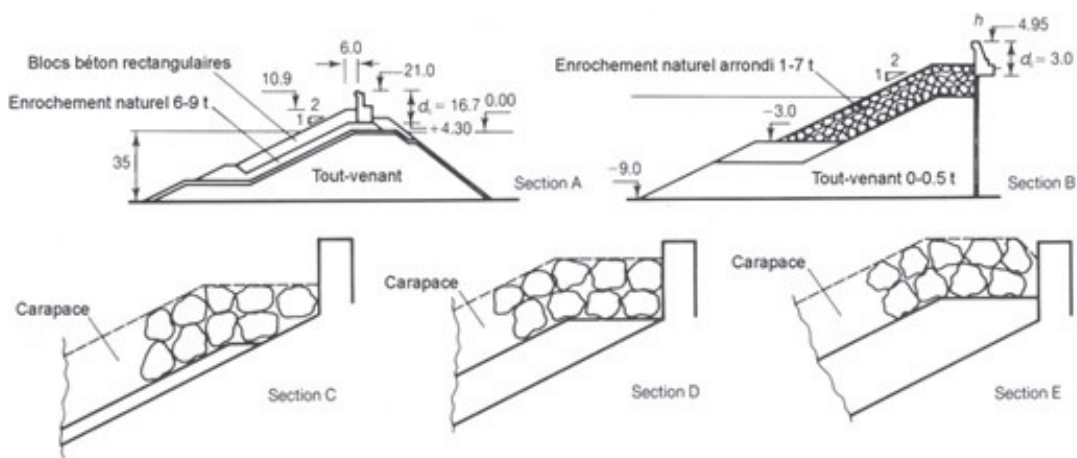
Sections des murs de couronnement des essais de Jensen, Bradbury et al.
